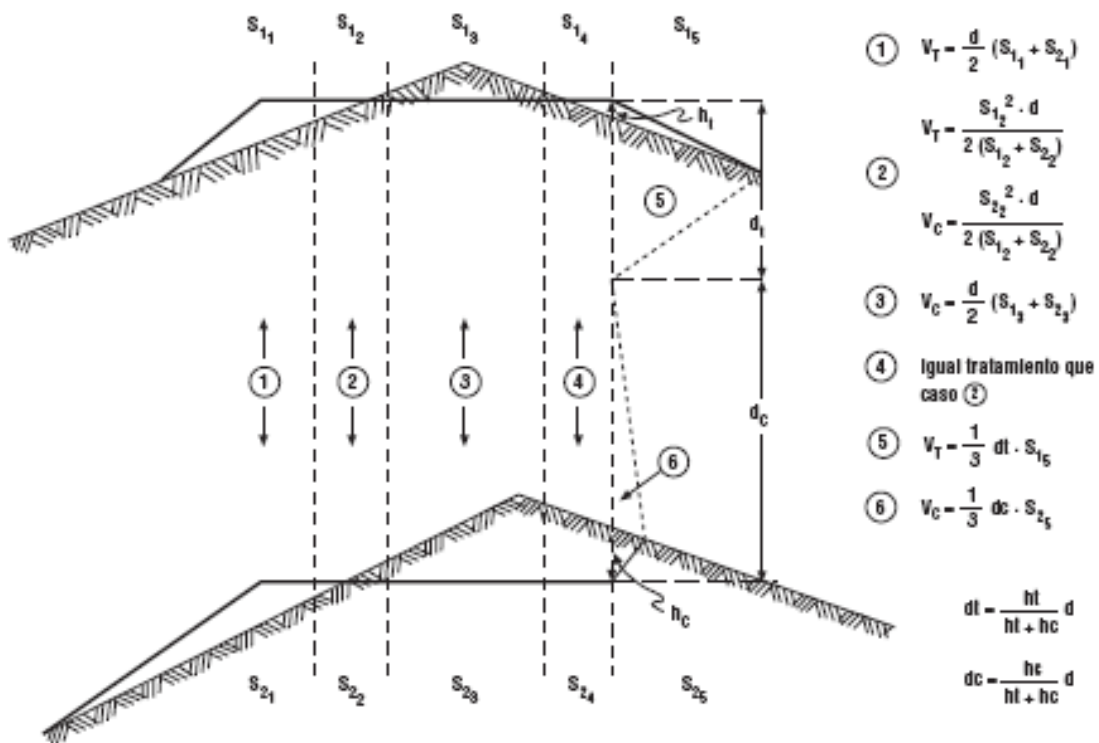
A.310-06Cubicacion de volúmenes - ilustración de casos particulares
